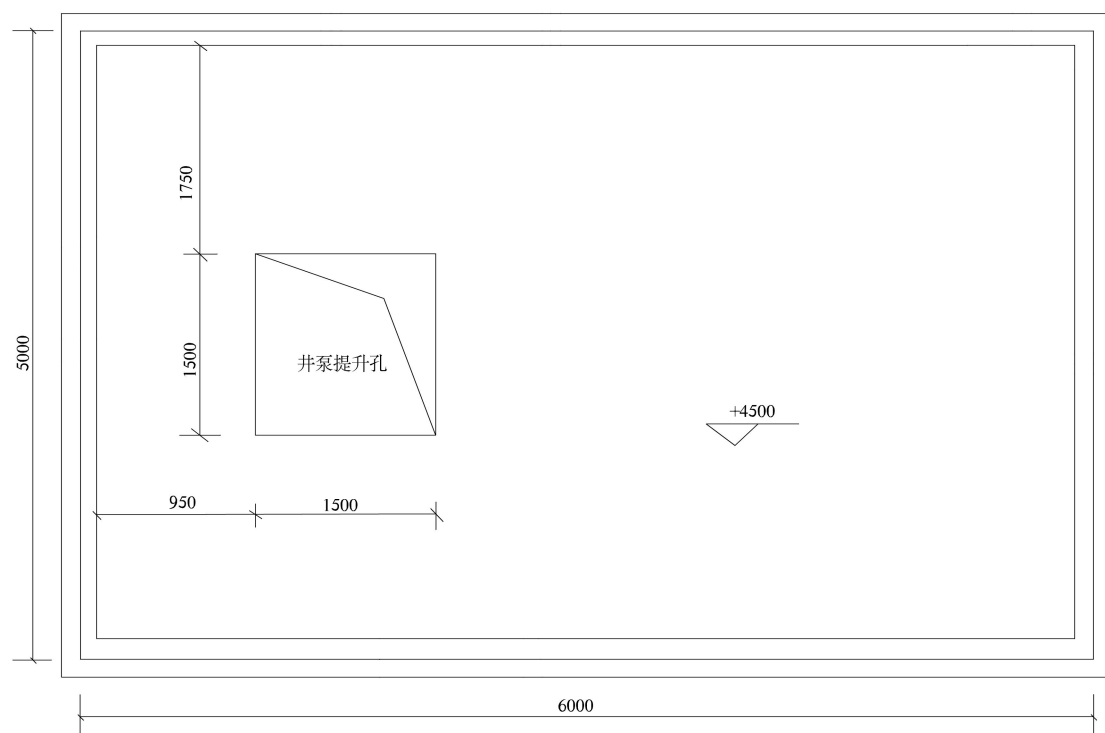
回灌井地上井泵房建筑房顶示意图 (单位: mm)
